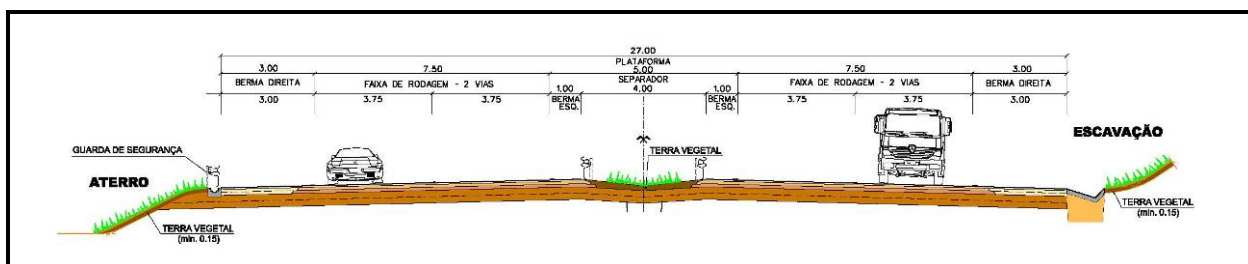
Perfil Transversal Tipo - Secção Corrente
